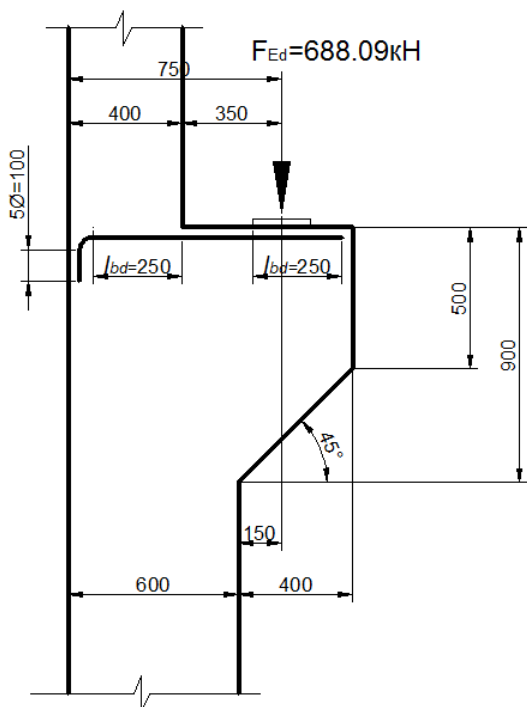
Анкеровка основной продольной арматуры консоли
